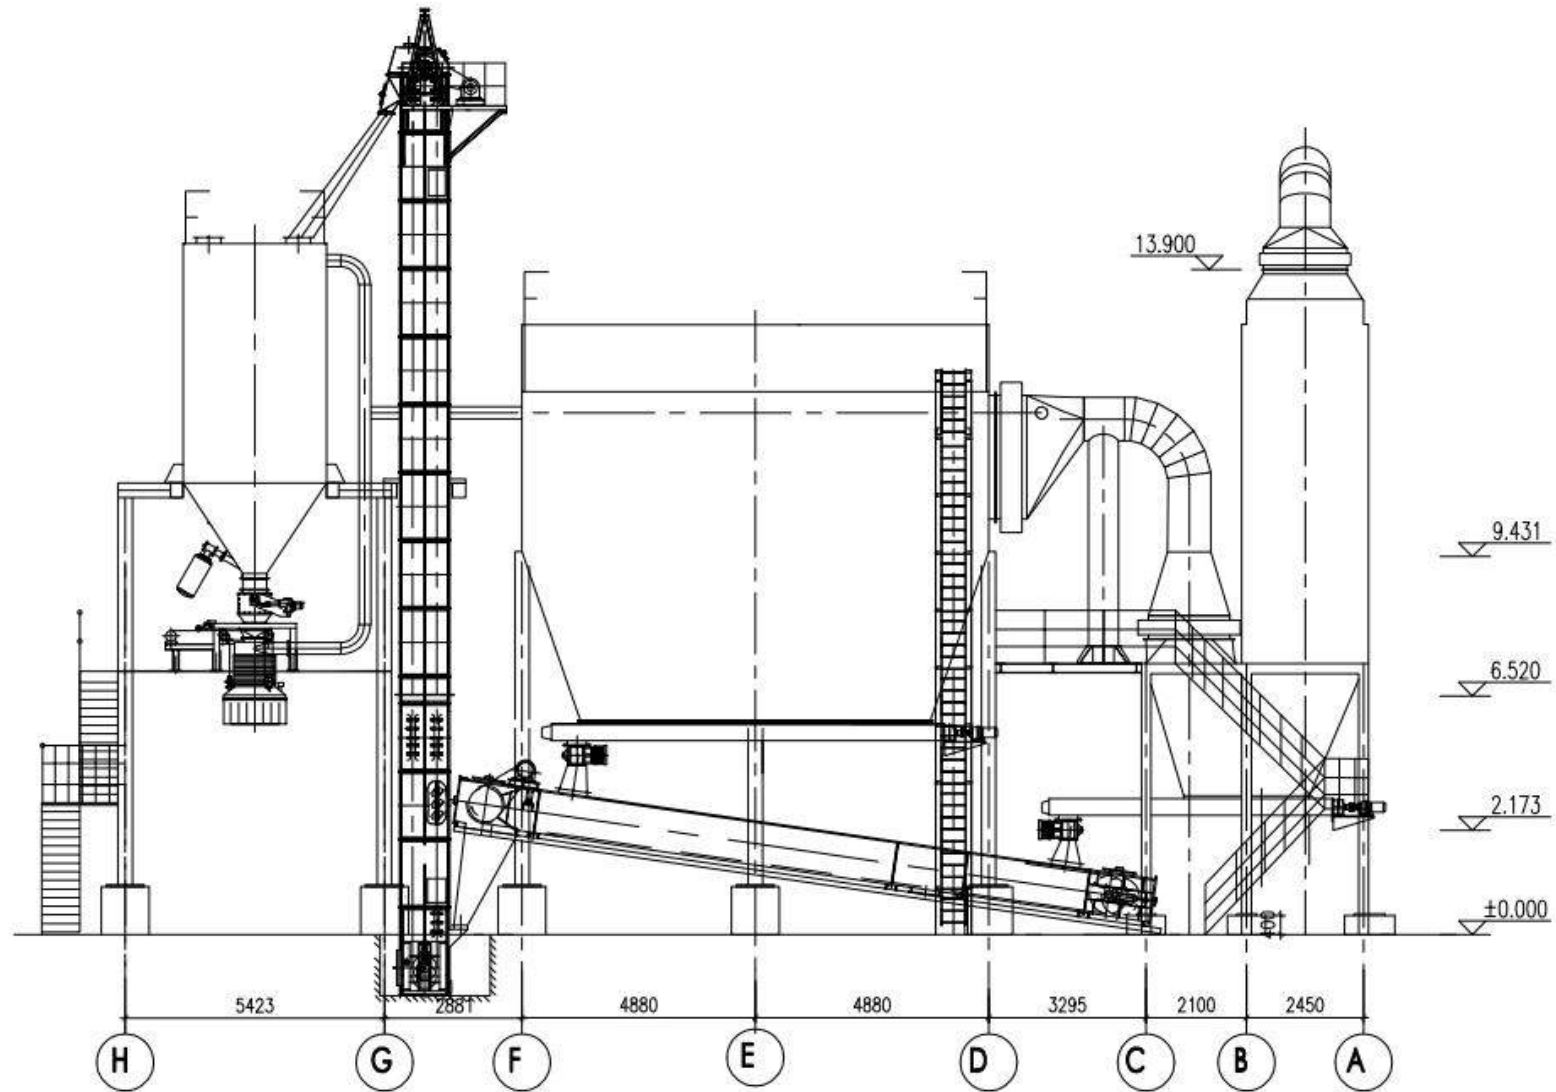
旁路放风系统立面图 (1-1 立面)
